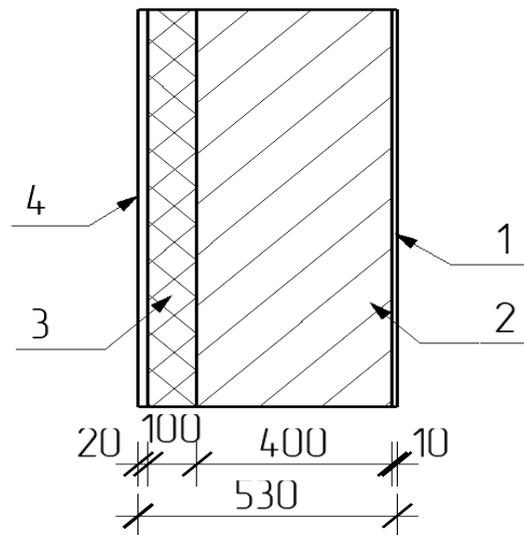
Стіна з утеплювачем, де: 1 – полімер-піщана штукатурка; 2 – бетонний блок; 3 – листи з жорсткої мінеральної вати; 4 полімер-піщана штукатурка.
